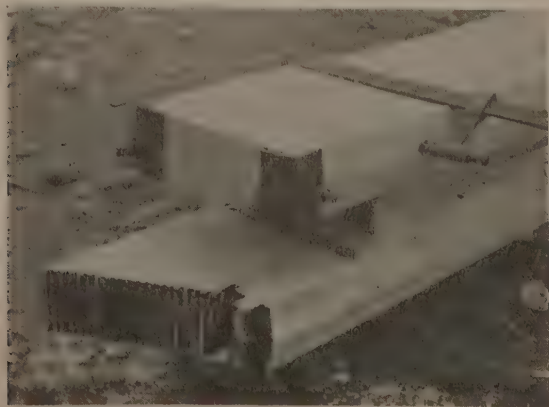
Fabrication de pieds de poteaux en bois lamellé collé.
